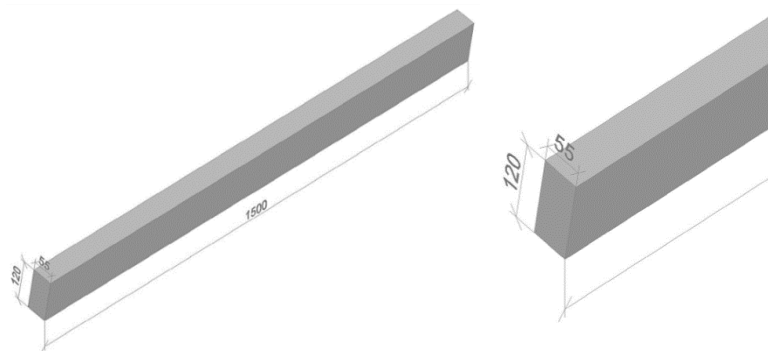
Sección teórica de viguetas o correas. Fuente: FIDICET
